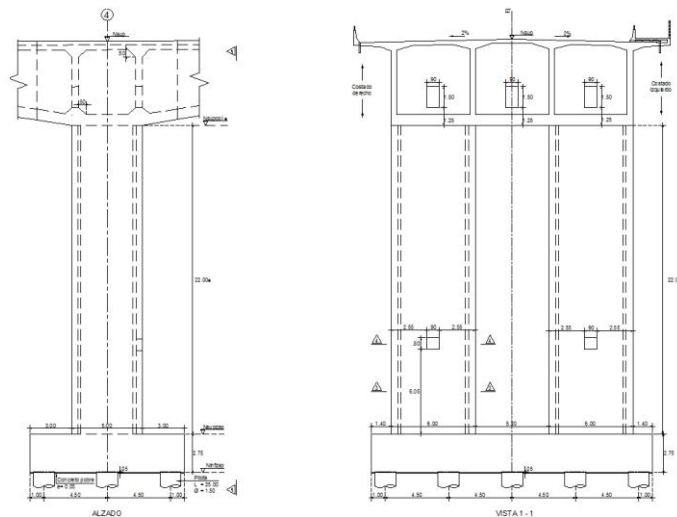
Par de columnas eje 4 puente central viaducto la unión (Gobernación de Santander)
